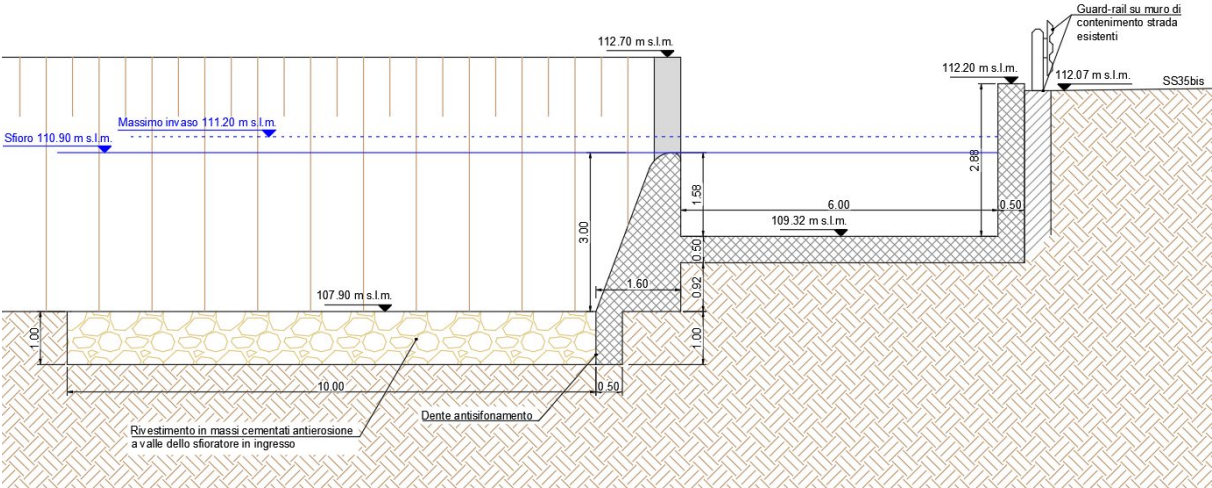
Particolare sfioratore di ingresso – sezione di monte
